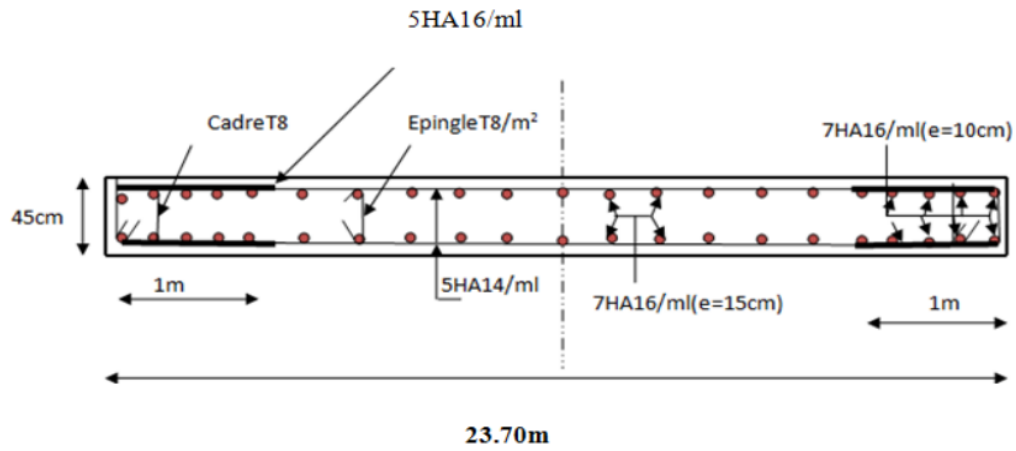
Ferrailage des voiles extérieurs en travée coupe (Y-Y').
